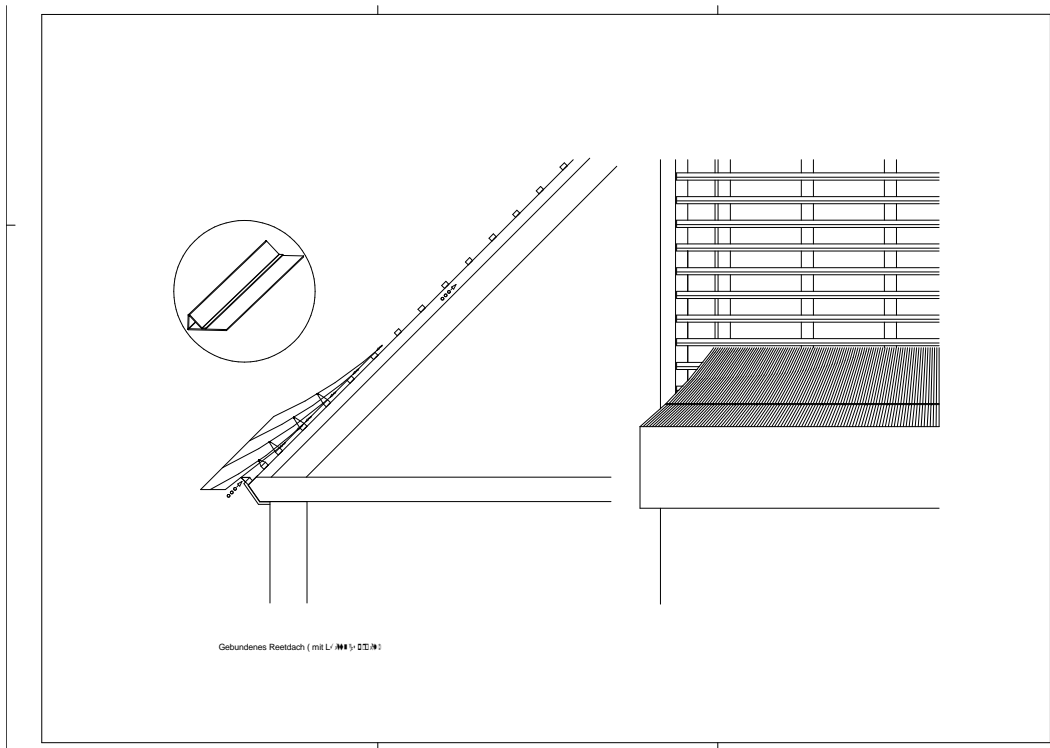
Gebundenes Reetdach (mit Gesimslüftung)
